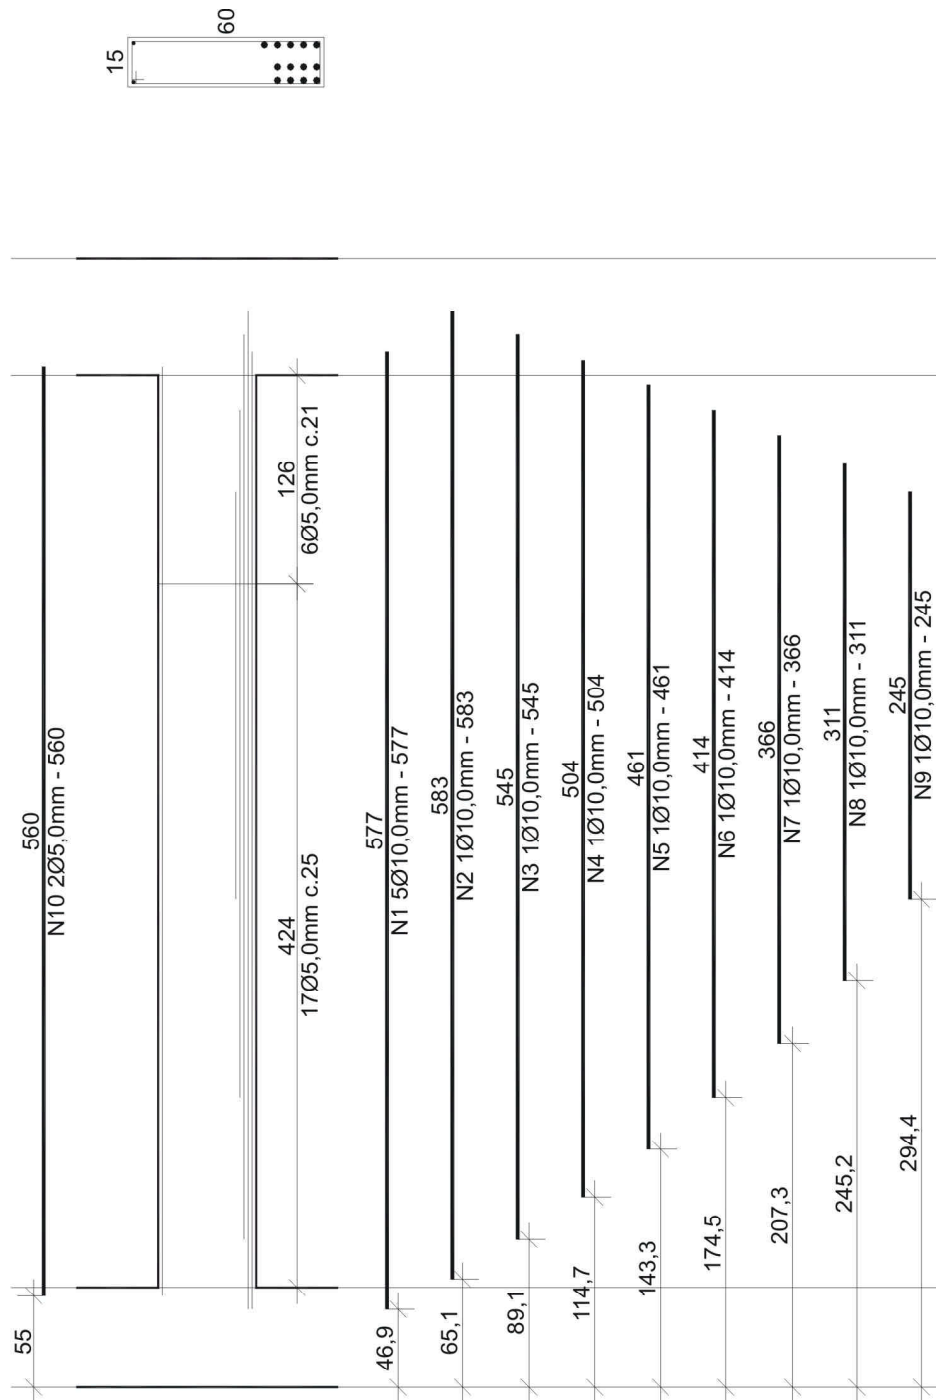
Detalhamento Viga 01, realizado pelo VigaCalc.
